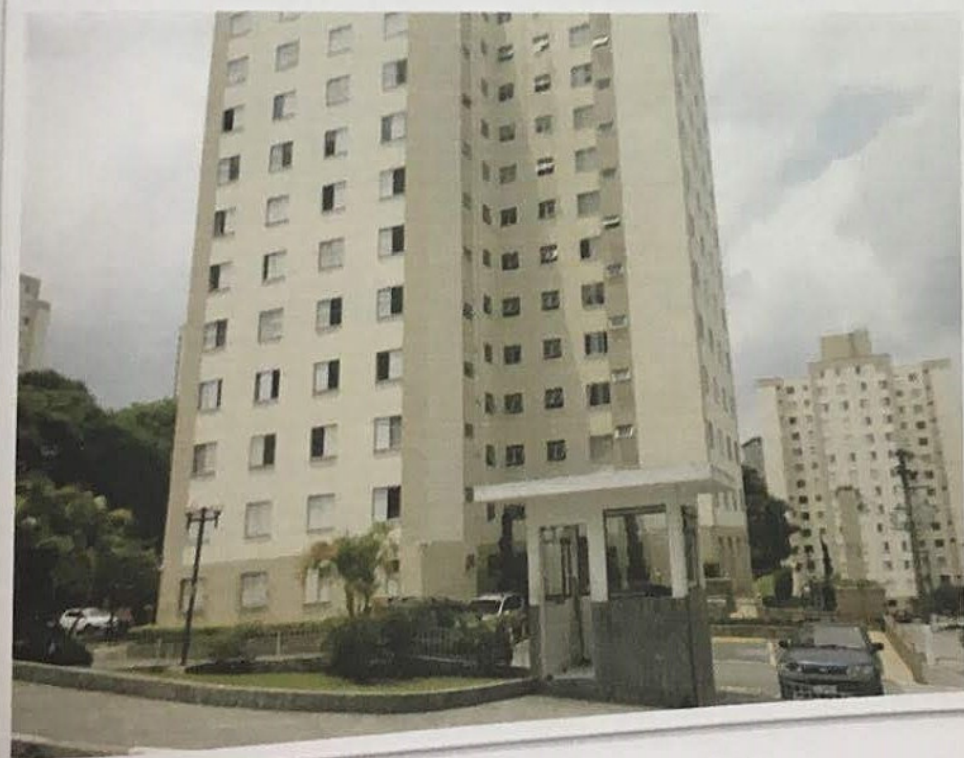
Vista parcial da fachada bloco nº 10.
